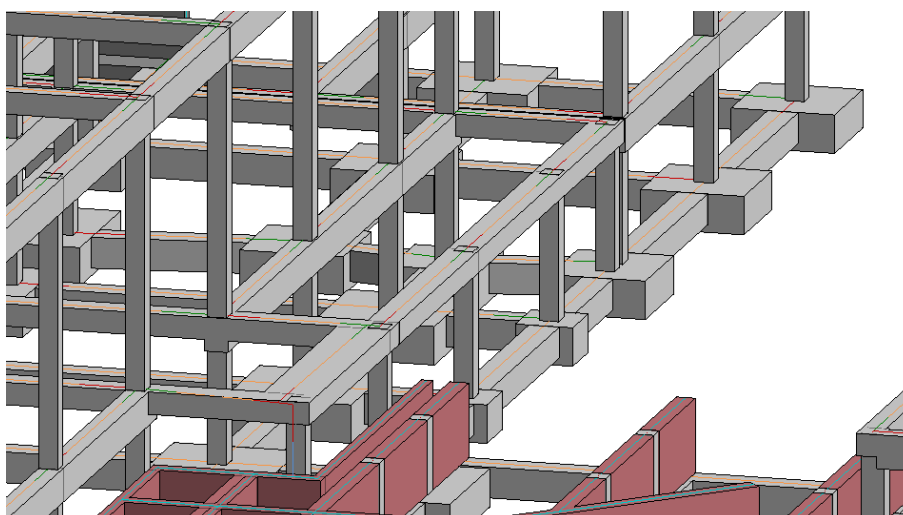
Vista 3D de los pilares que van hasta la altura de forjado de planta baja de zona administrativa
